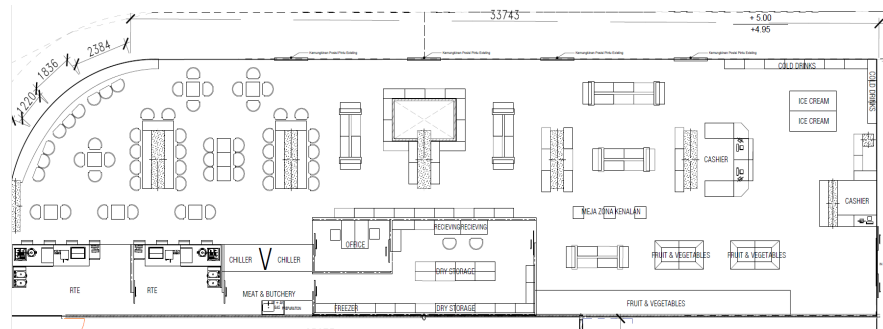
20 Denah Upper Ground Floor Mall Lagoon Avenue
